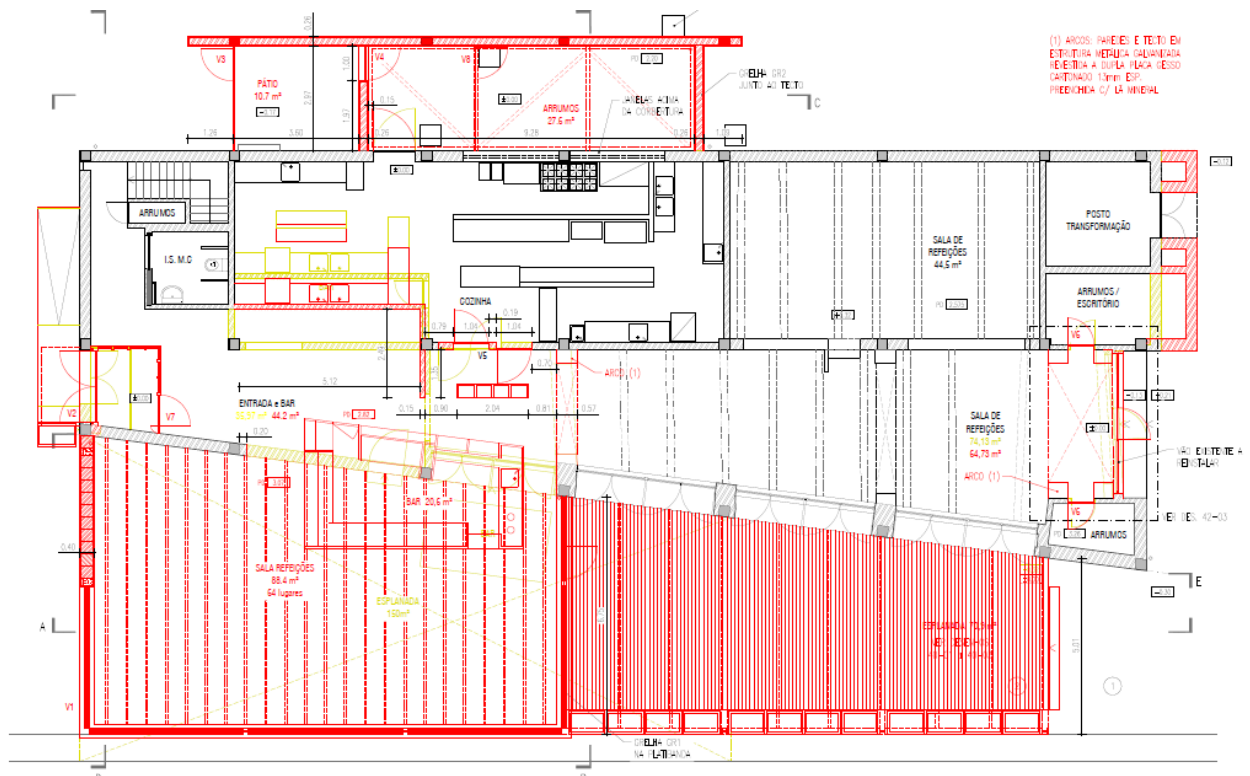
Projecto de Arquitectura - Planta de Alterações
